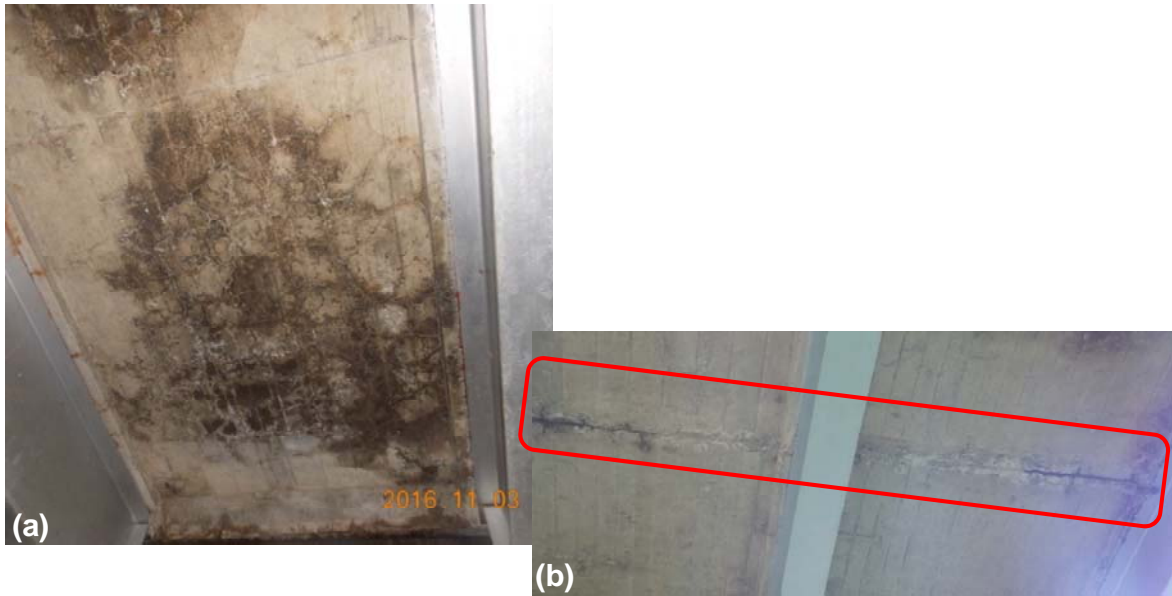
Losa de concreto superestructura 2: (a) Deterioro avanzado con alta incidencia de humedad y eflorescencia ; (b) Evidencia de eflorescencia en juntas de construcción.
